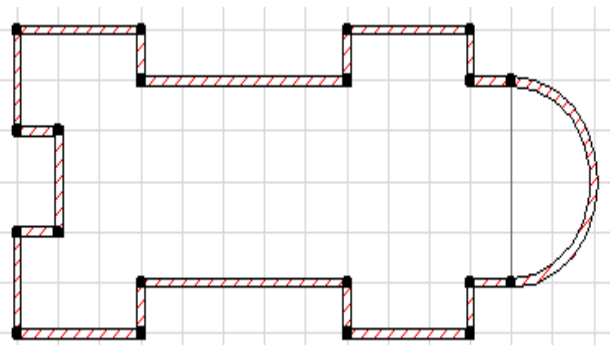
Точки кутів перекриття будівлі №2.2
